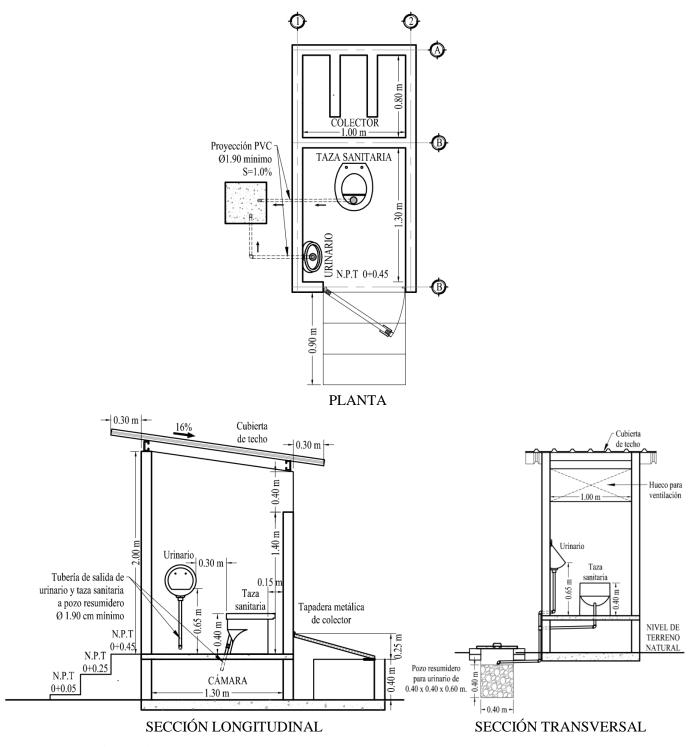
Vista en planta y elevación de los detalles constructivos de letrina de doble cámara
